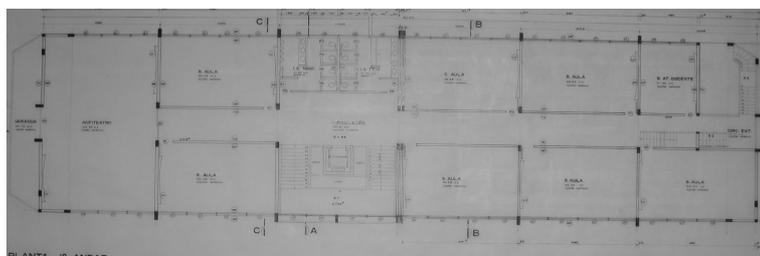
Planta do primeiro pavimento de um bloco-módulo padrão de três pavimentos [1977].
